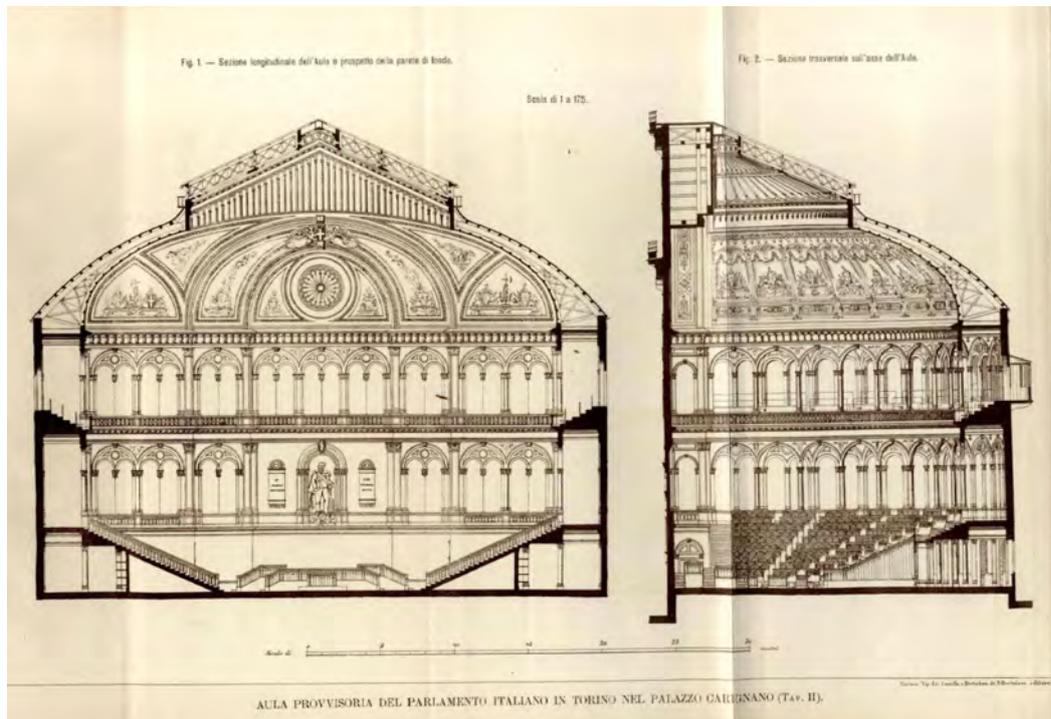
Sezione longitudinale dell'Aula e prospetto della parete di fondo; Sezione trasversale sull'asse dell'Aula. In *L'ingegneria civile...* (1898), XXIC, 9.
